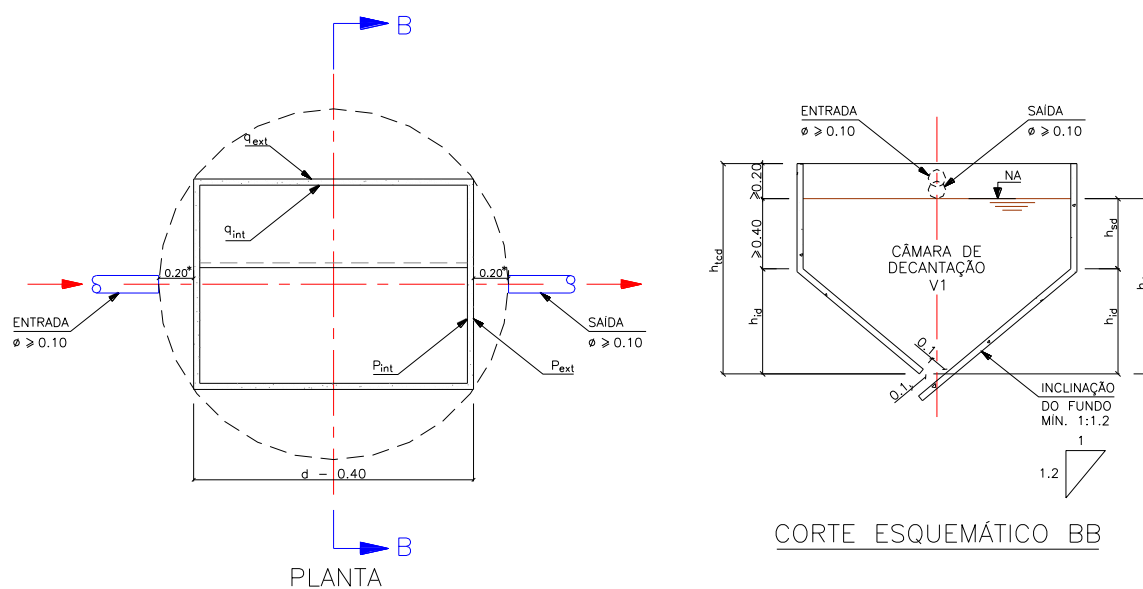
Representação Esquemática da Câmara de Decantação em Planta e Corte.
